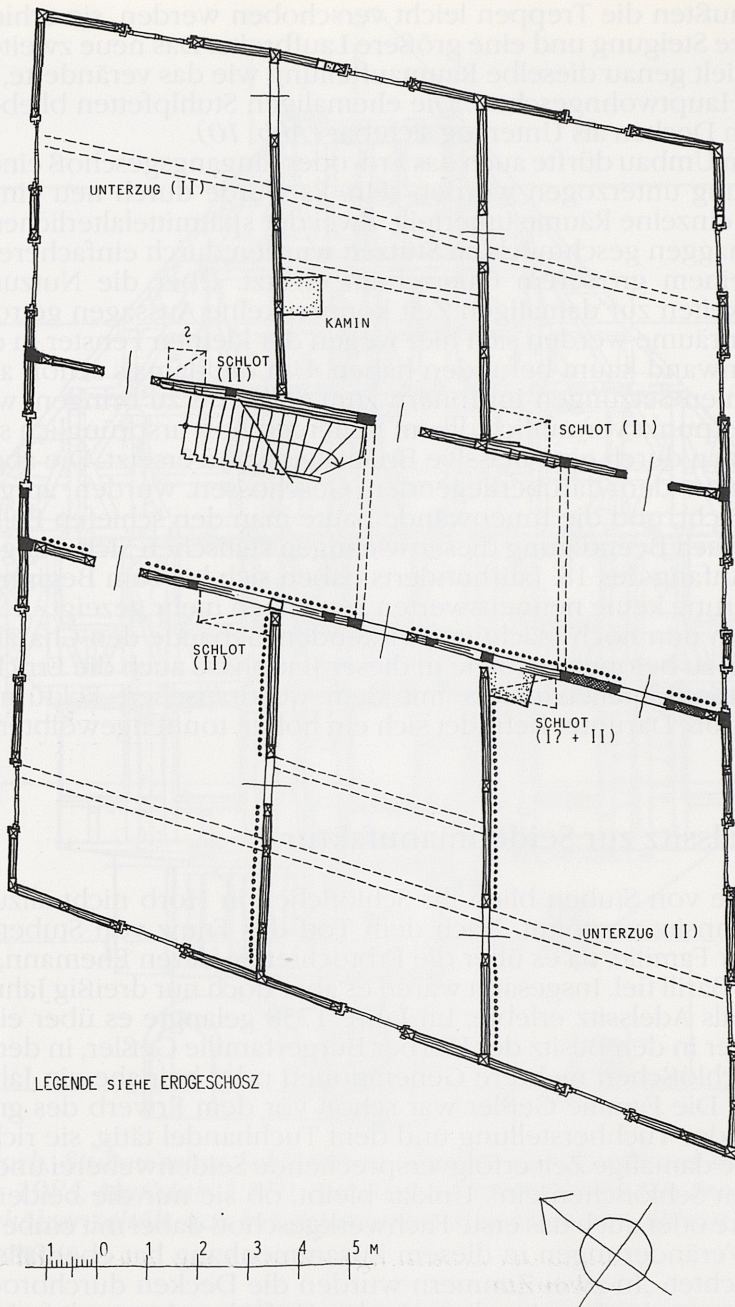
Horb, Stuben'sches Schloßchen. Baualtersplan des zweiten Obergeschosses, Maßstab 1:150. Nur wenige Bauteile aus dem 16. Jahrhundert haben sich im ehemaligen unteren Dachboden nach der barocken Veränderung erhalten.
